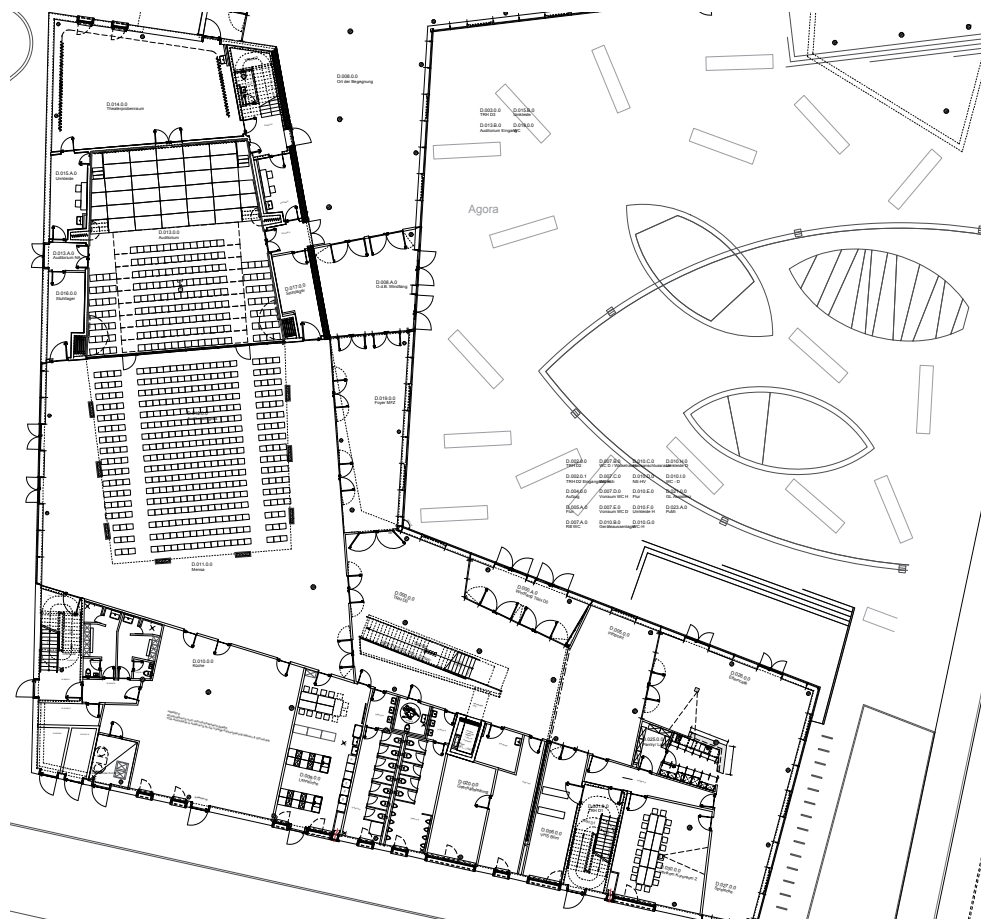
Grundriss EG: Mensa und Torhaus (Ausschnitt)
